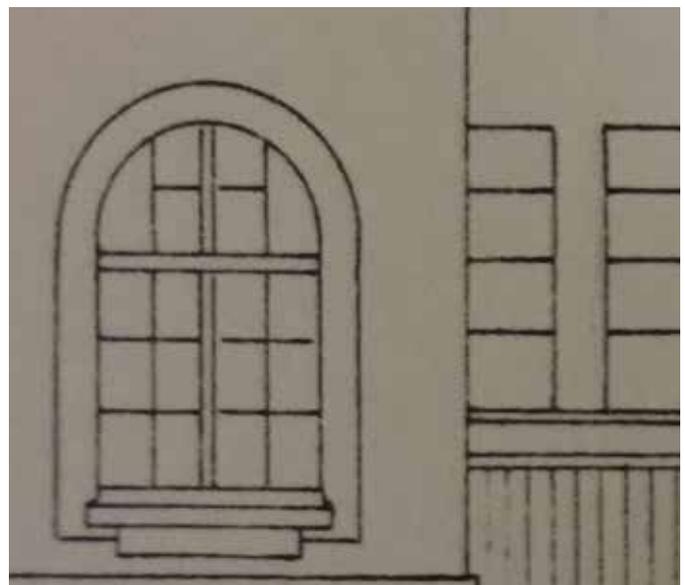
Ausschnitt der Originalansicht eines Kantor Haus- Fensters
